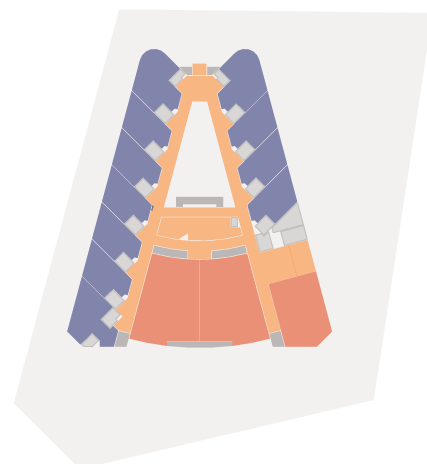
Planta do Segundo Pavimento - Tipo 2.
